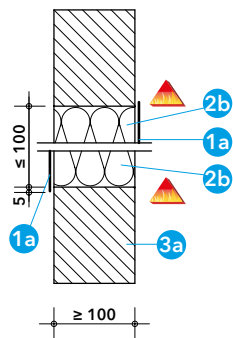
Detail F - vodorovná spára mezi stěnovou konstrukcí a trapezovým plechem (není dilatační)
